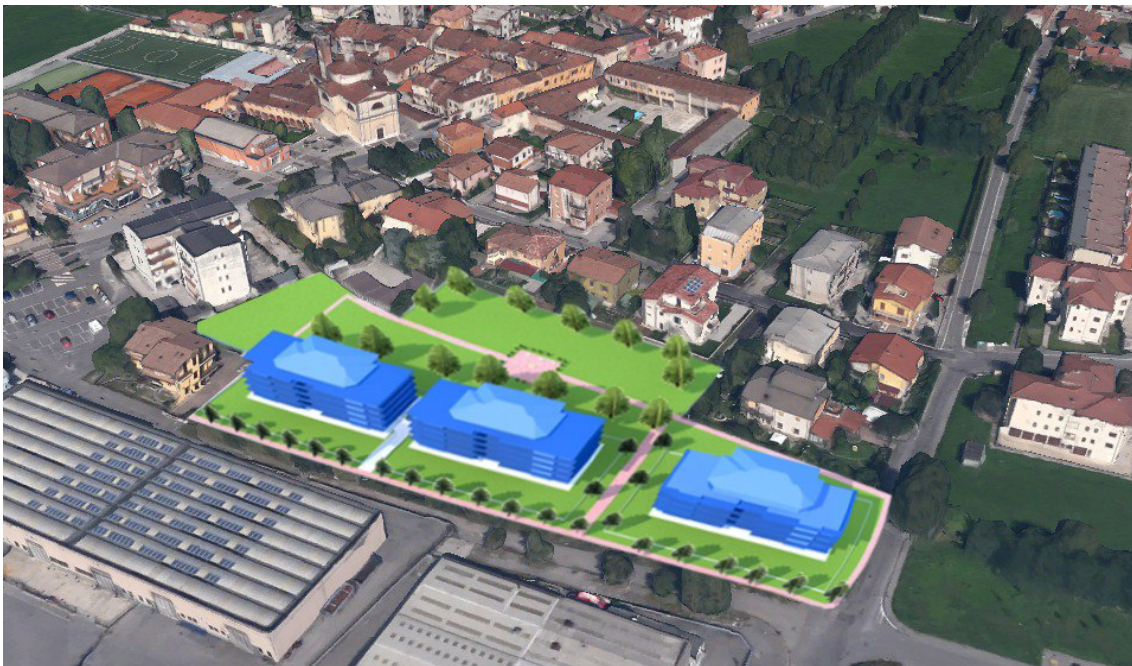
simulazione grafica del progetto approvato del Piano Attuativo.
